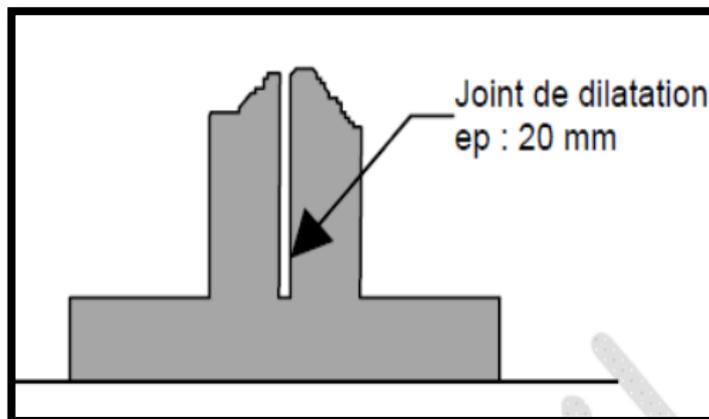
coupe schématique du joint de dilatation en fondation (source : auteur).
